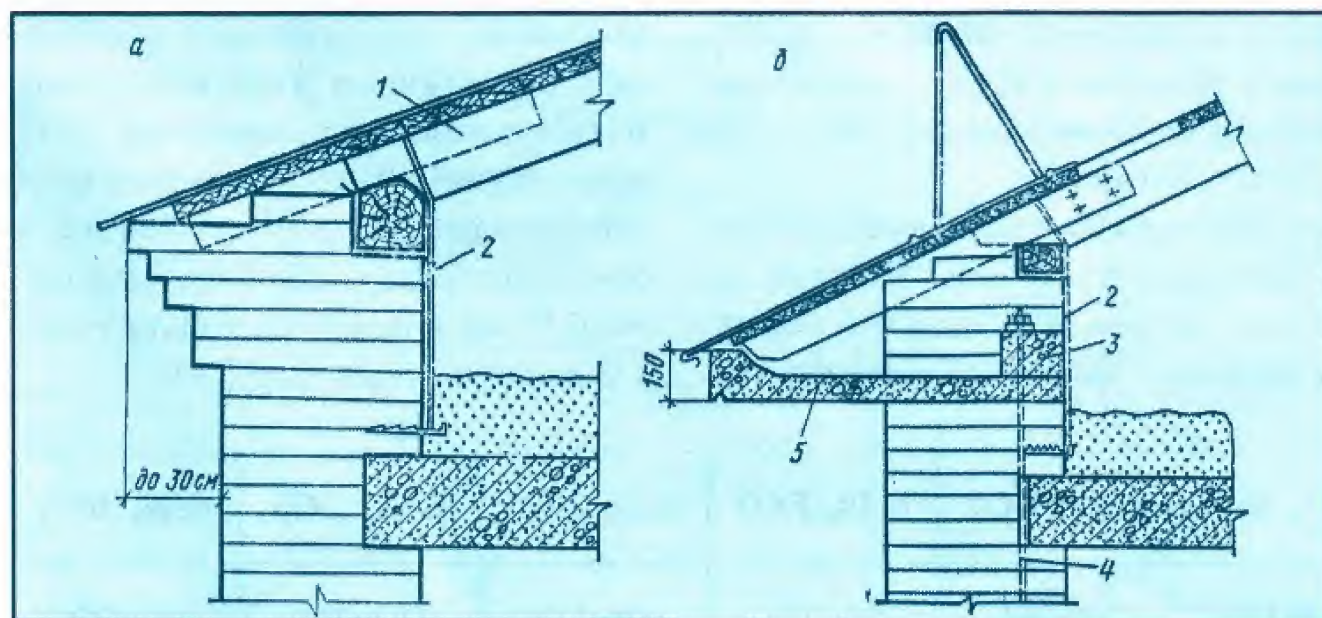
Карнизи, що завершують цегляні стіни: а - карниз цегляний; б - карниз із збірних залізобетонних плит; 1 - кобилка; 2 - скрутка; 3 - анкерна балка; 4 - анкер; 5 - карнизна плита.
